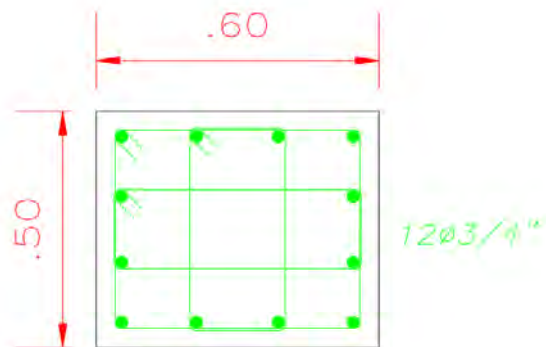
Sección de viga de cimentación (Fuente: Propia)
